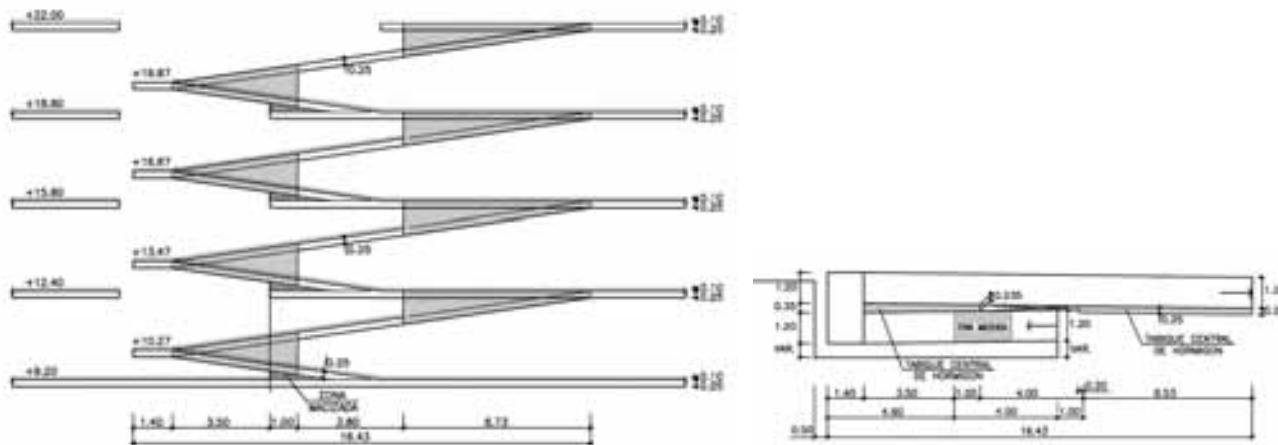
Esquema en alzado y planta de la rampa del Centro Coreográfico
